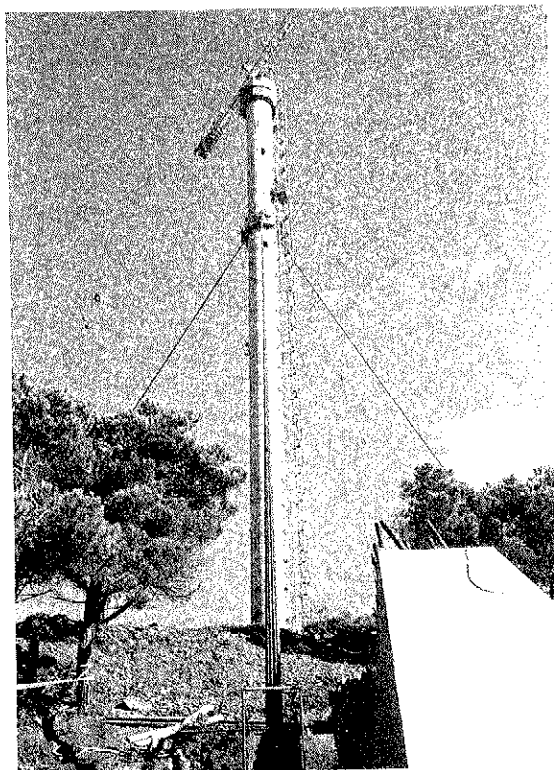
Anclaje al terreno. Cables provisionales C-1.
